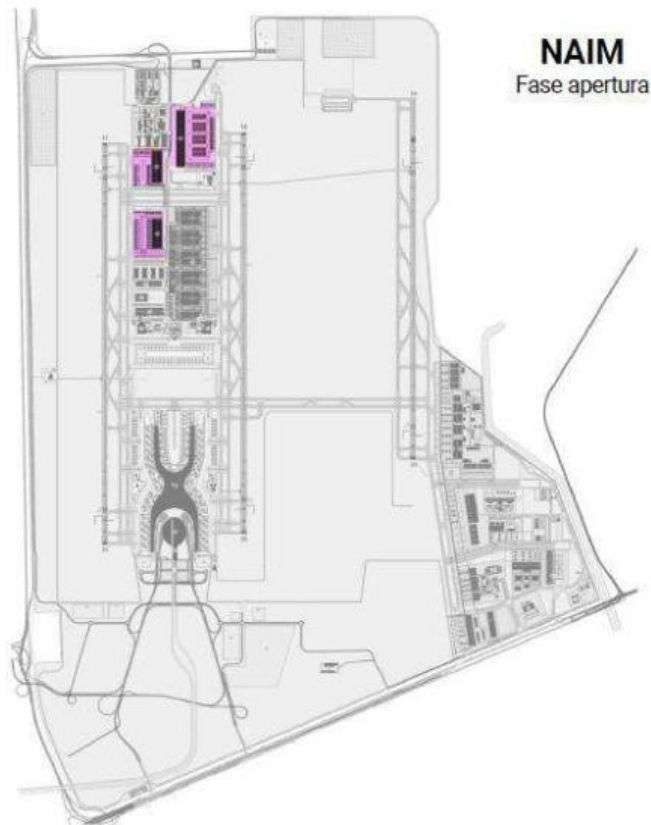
Ubicación de Planta Central de Servicios, Mantenimiento NAICM.
